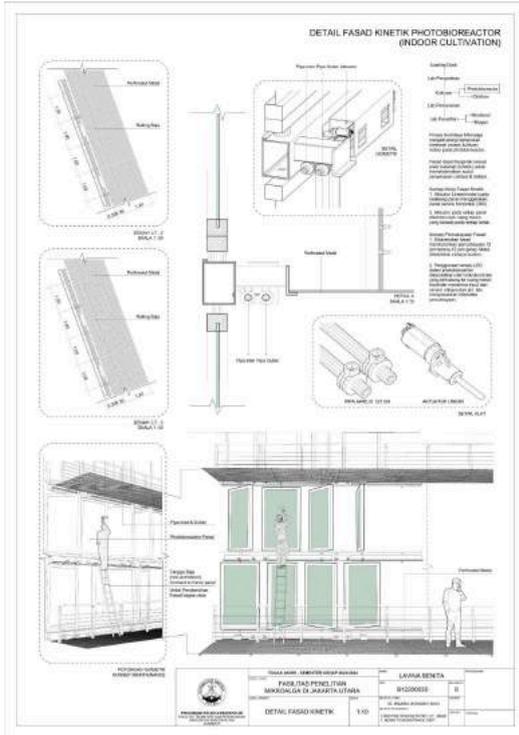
3. Diagram & Detail Tower Mikroalga
